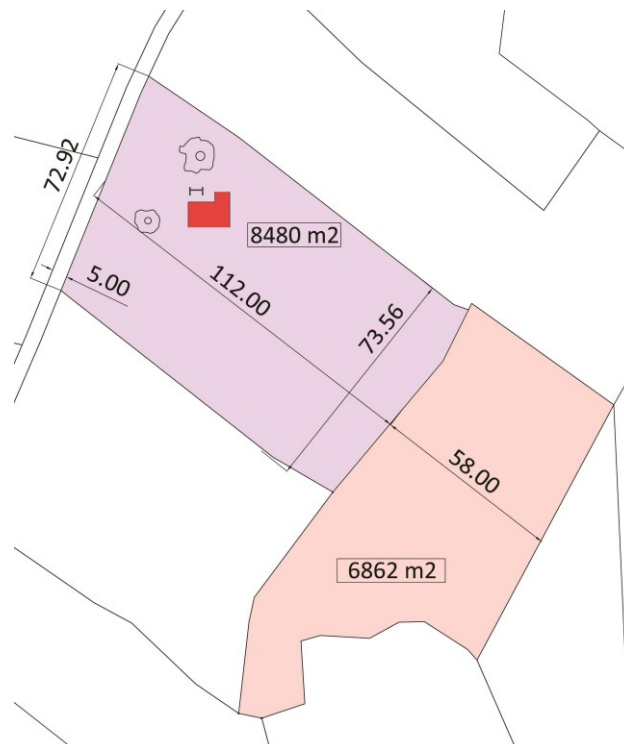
Superficie de las parcelas (sin escala). 2016. Editado de plano de emplazamiento.
